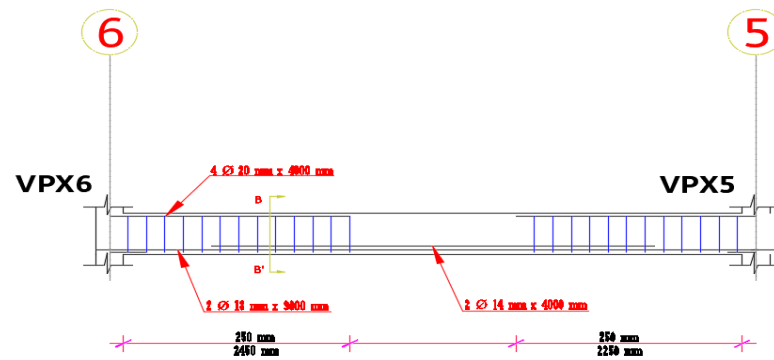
Detalle de viga secundaria, piso 2-3-4.
